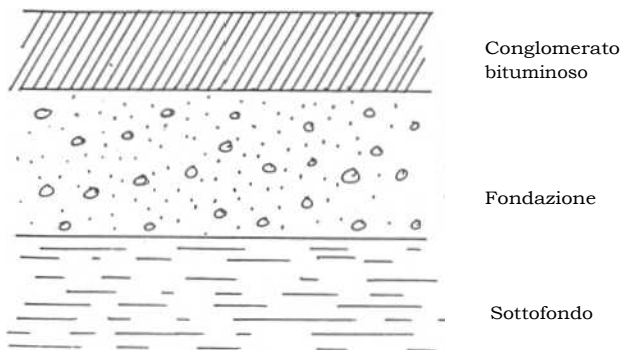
Rappresentazione della pavimentazione con un modello a 3 strati
